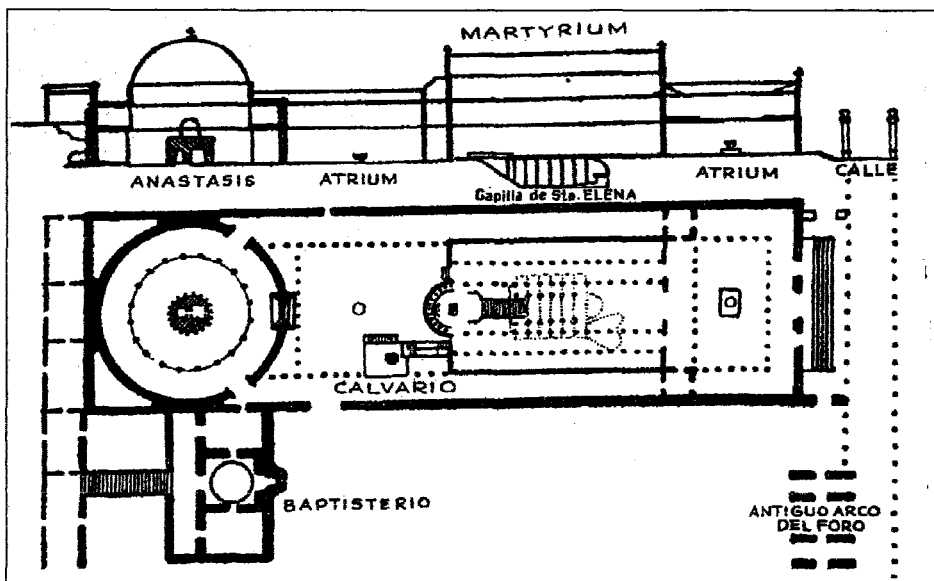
Planimetría del Santo Sepulcro de Jerusalén.
